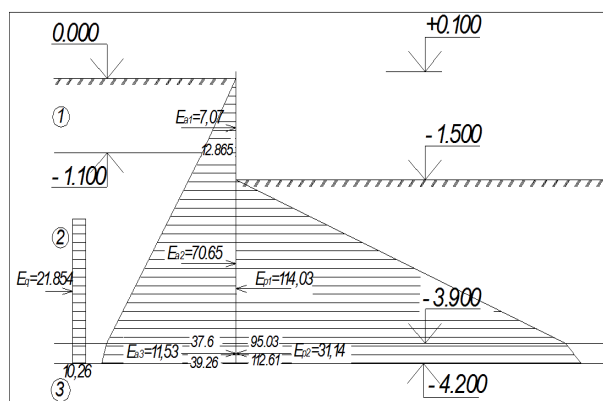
Схема к расчету подпорной стены на первом этапе
